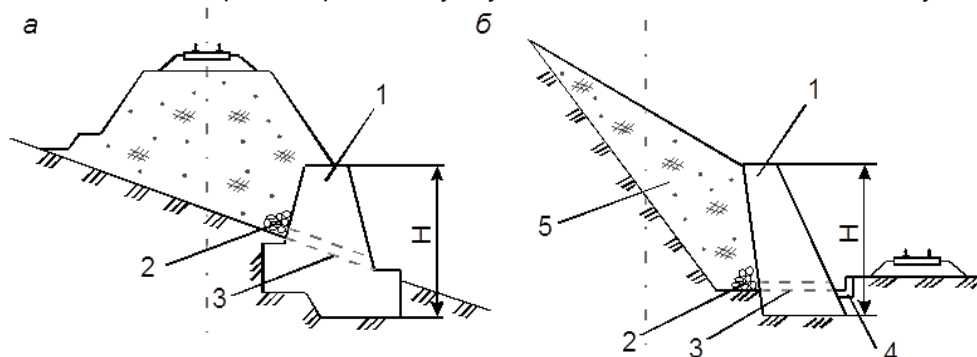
Подпорная стенка: а – низовая; б – верховая; 1 – подпорная стена; 2 – каменный дренаж; 3 – выпуск дренажа; 4 – канава; 5 – обратная засыпка
